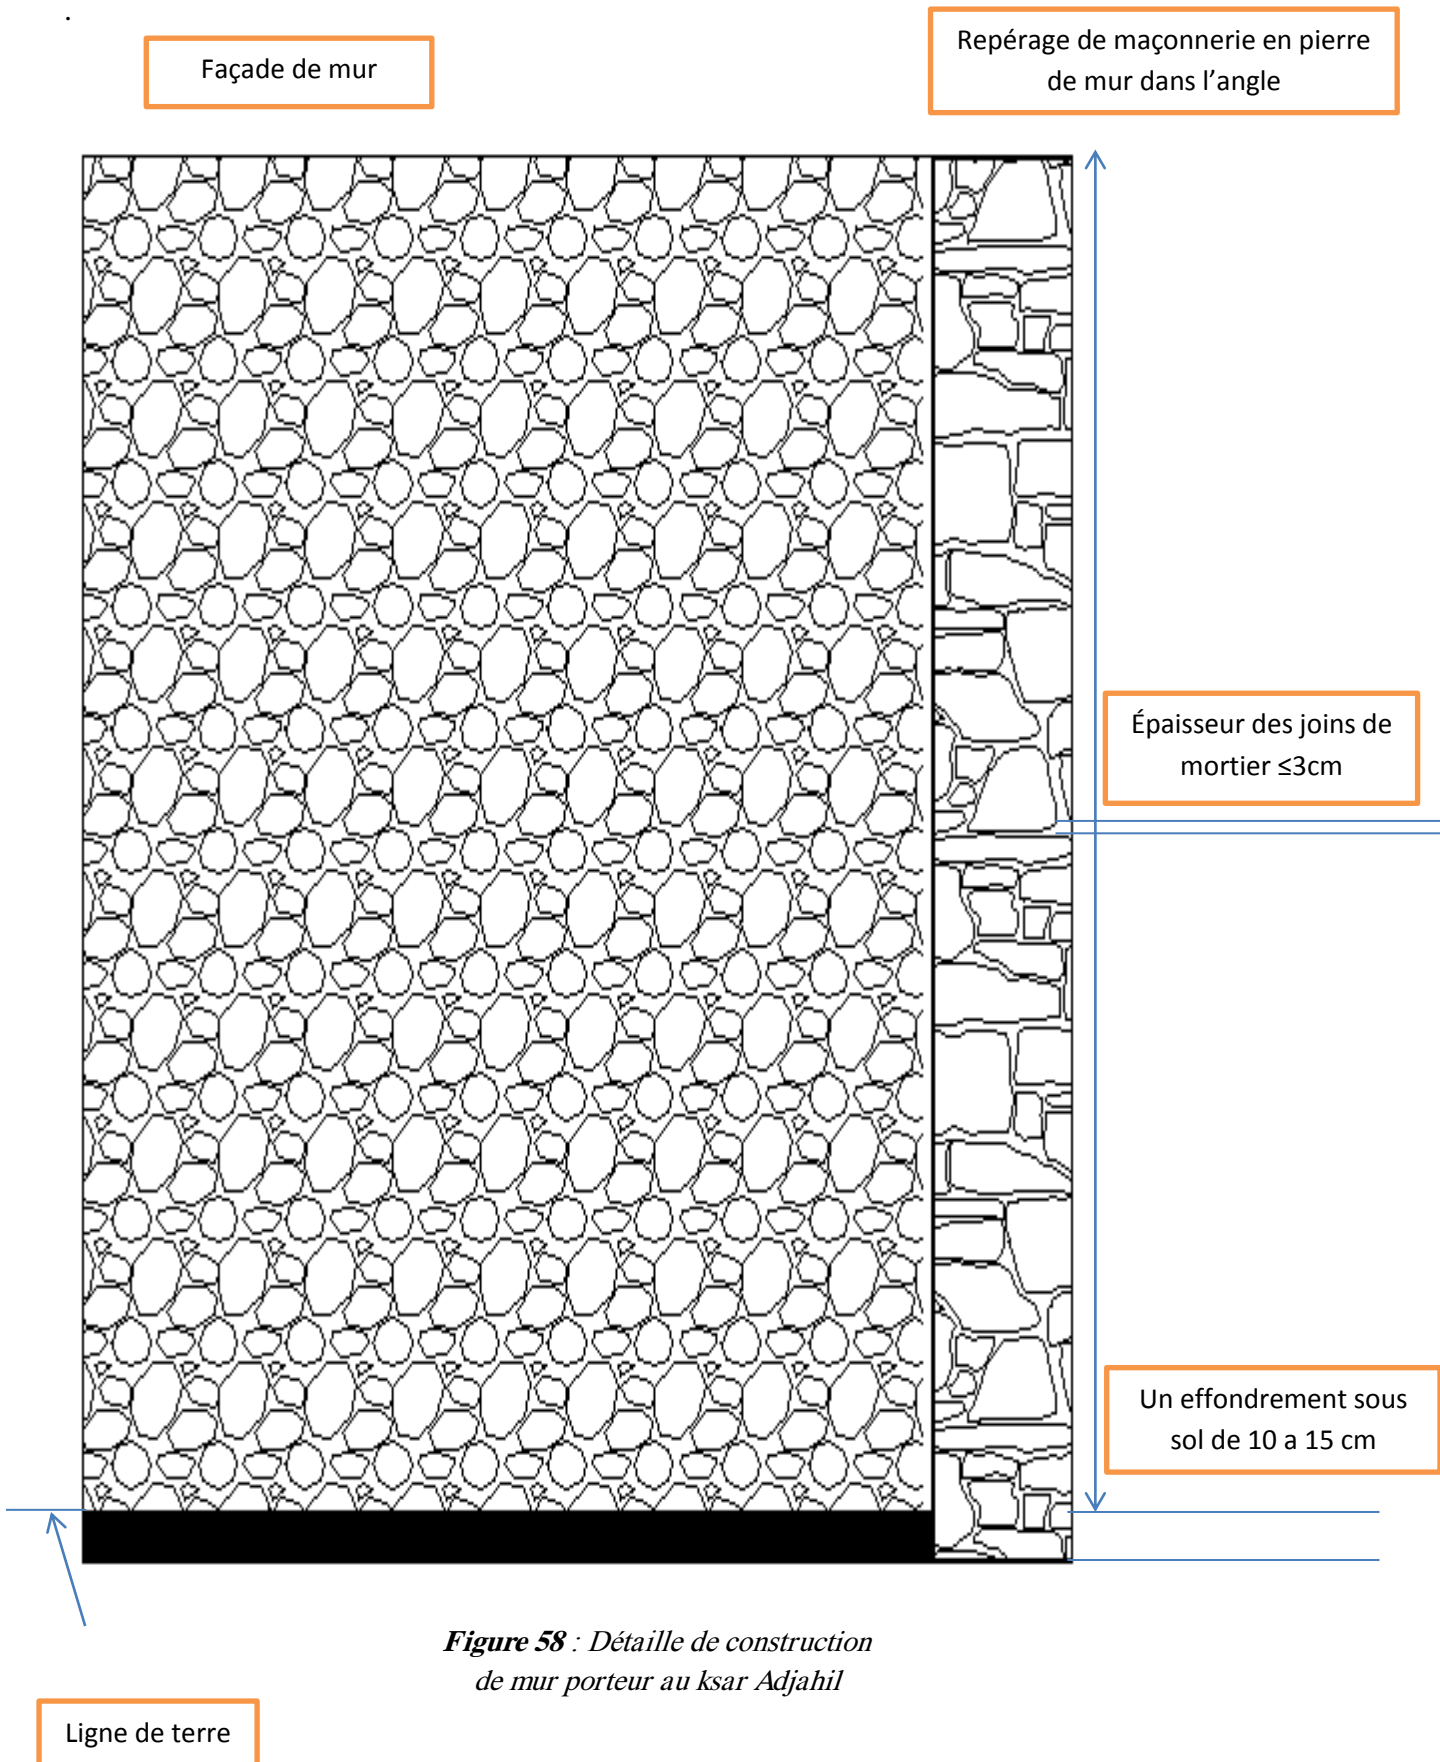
Détaille de construction de mur porteur au ksar Adjahil
